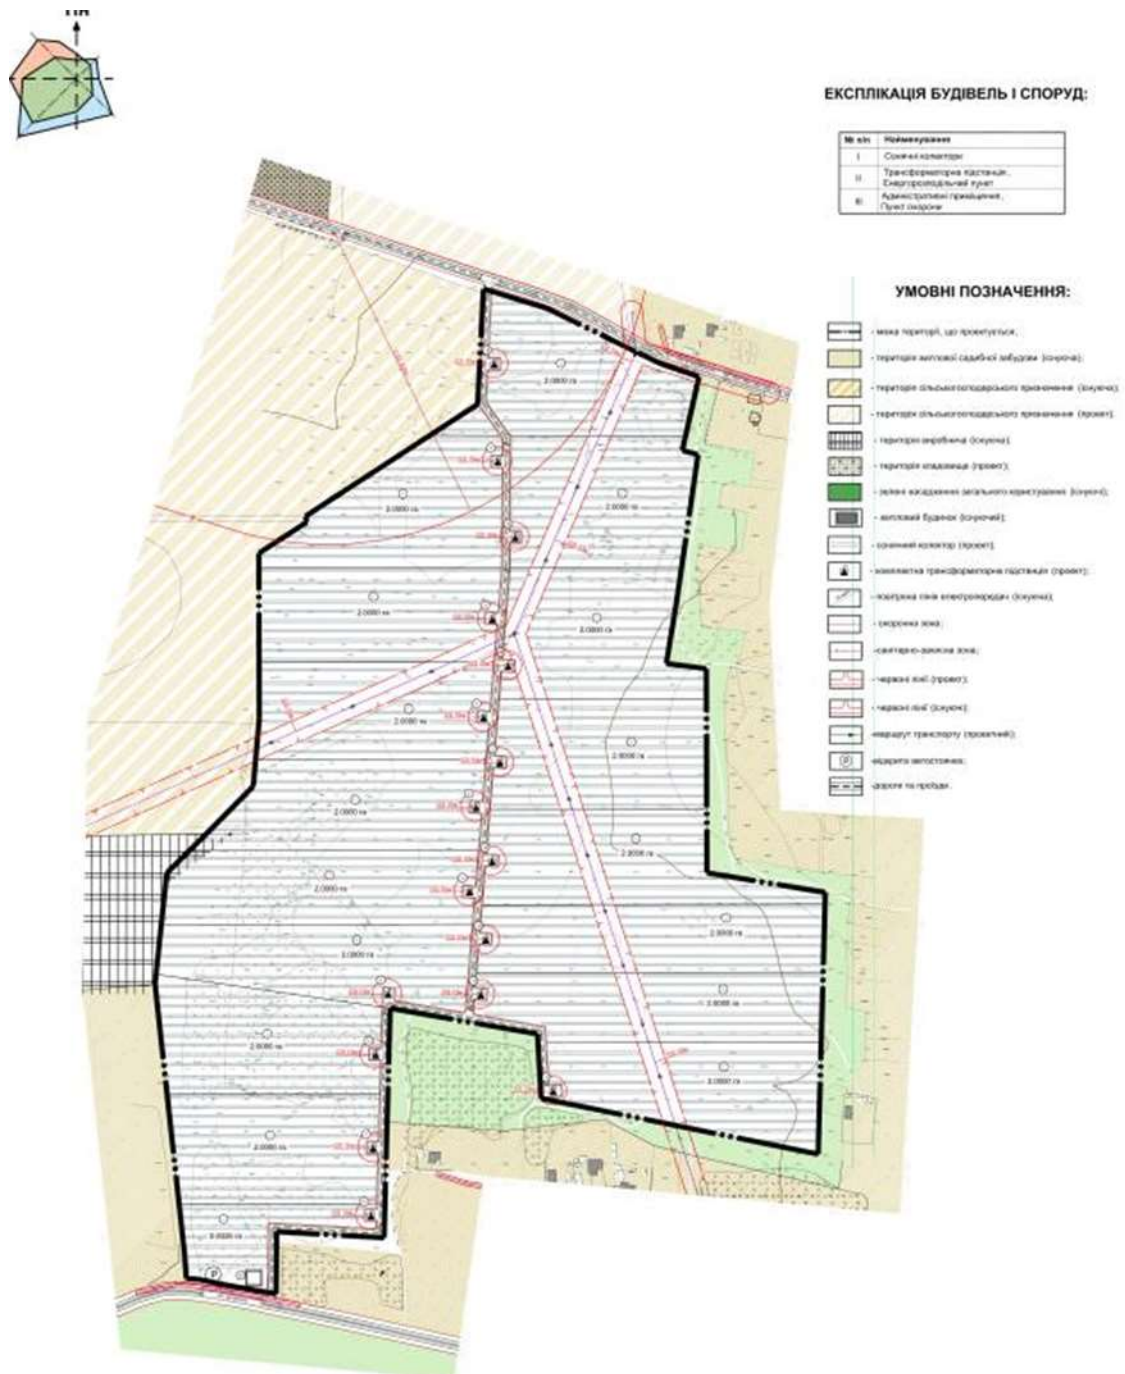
План забудови території та схема передбачених планувальних обмежень
